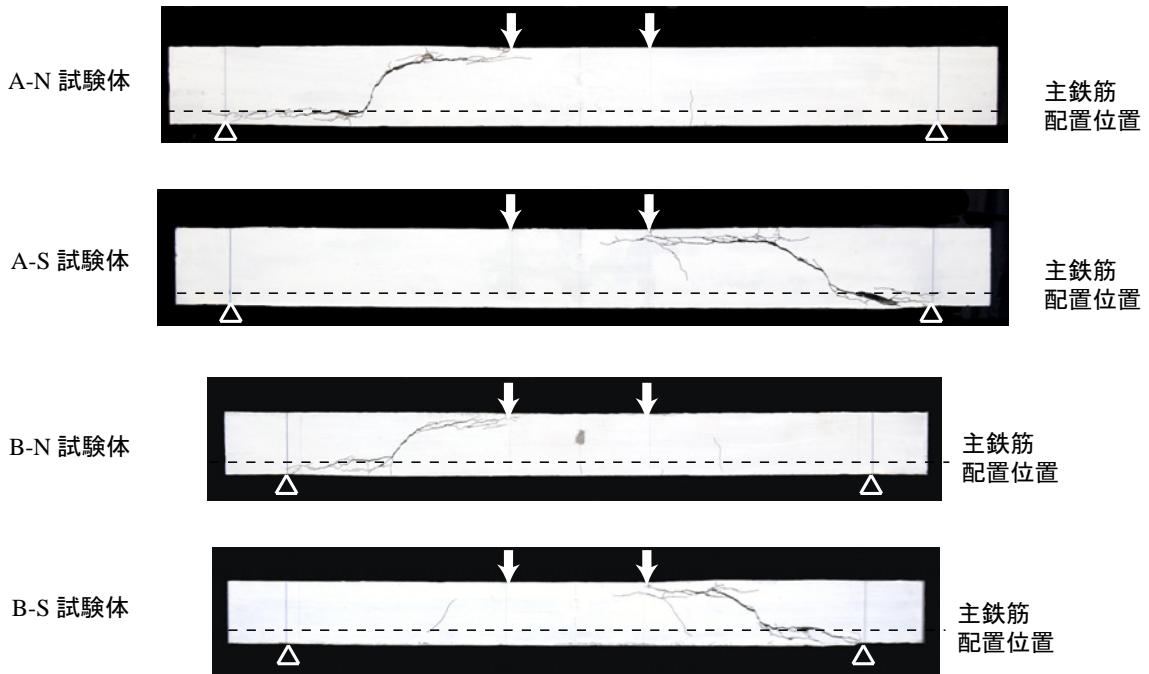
実験終了後におけるRC梁側面のひび割れ状況
